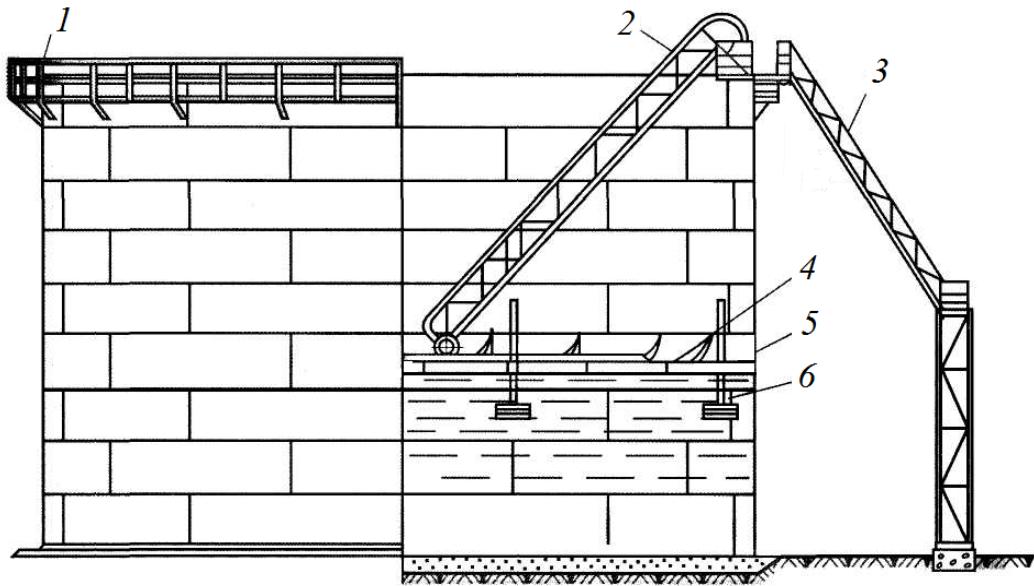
Общий вид резервуара с плавающей крышей:
